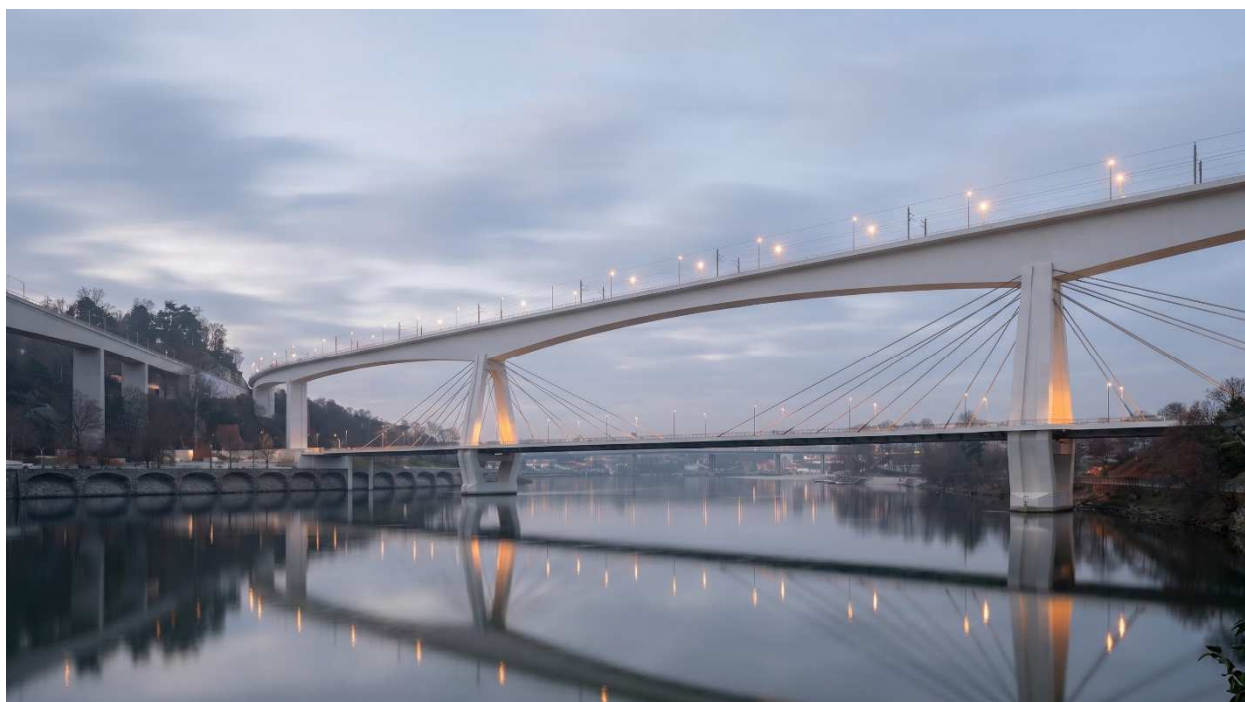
Vista de jusante da solução proposta (fotomontagem)
